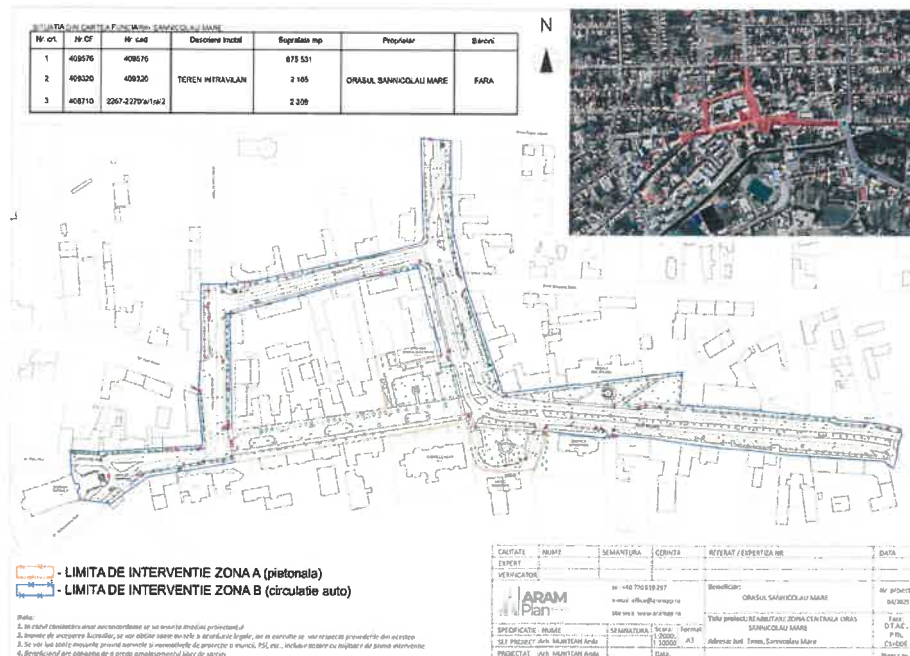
Extras din plan de încadrare în zonă cu delimitarea zonelor de intervenție
